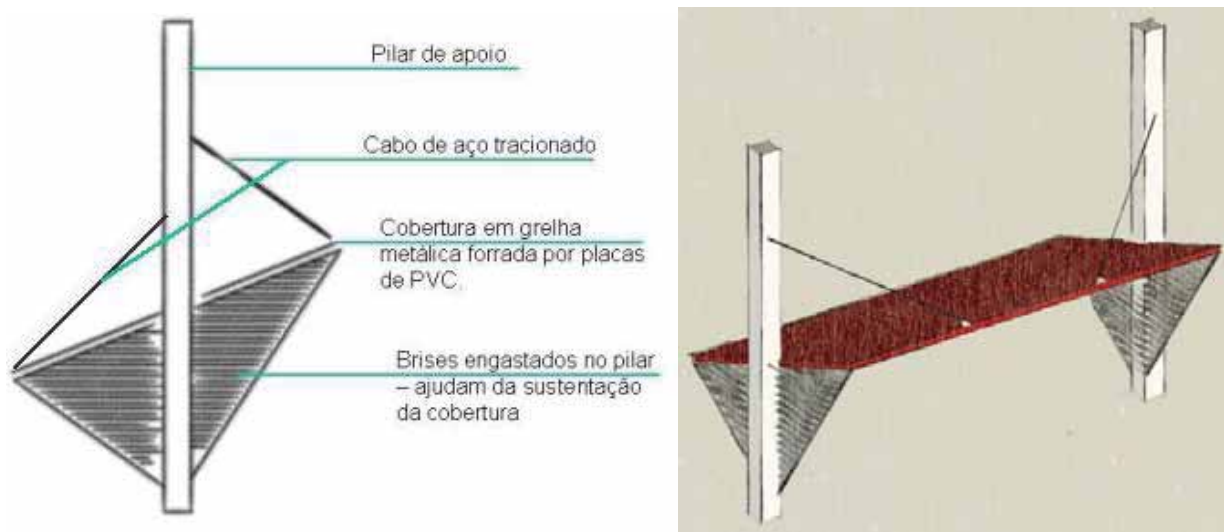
e 73: Corte esquemático da cobertura da entrada principal e vista da cobertura e seus apoios.
